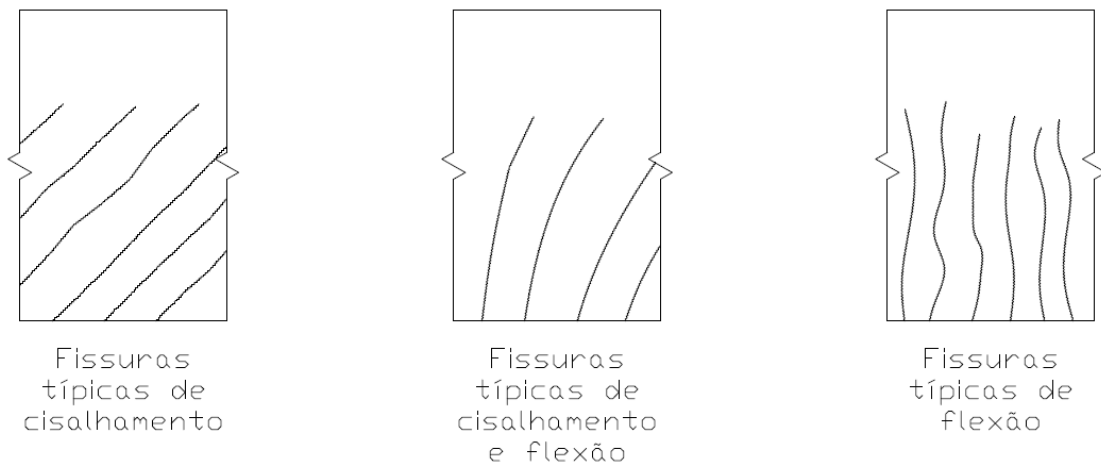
Fissuras típicas na flexão simples.
